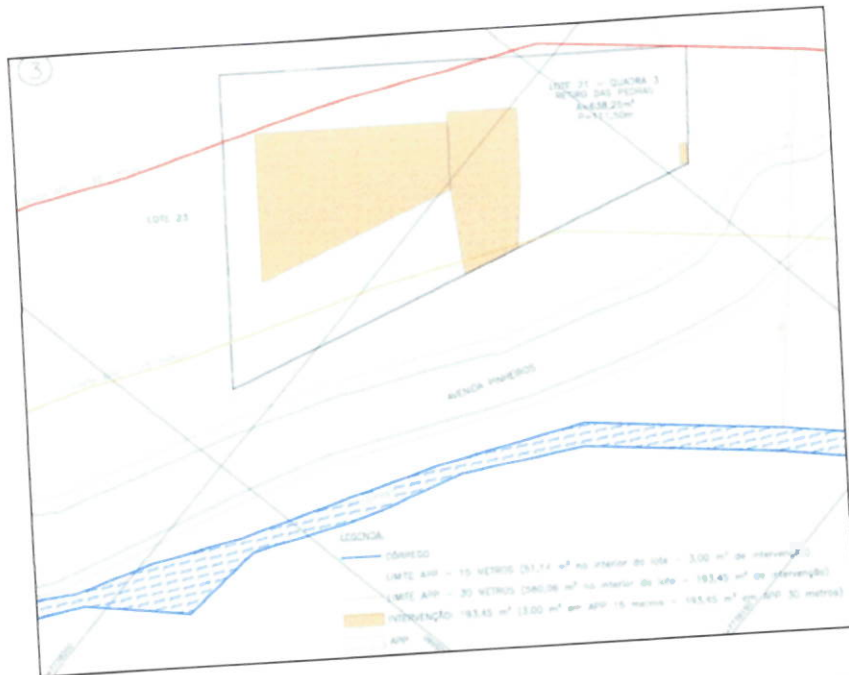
Planta de identificação da área de intervenção e APP. Fonte: Arquivo SEMA LAE 244/2025.
